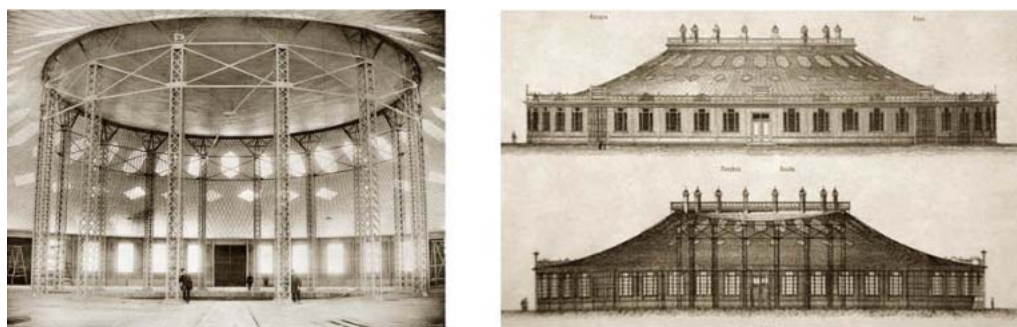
Shukhov Rotunda, 1896. Átrio Central, Elevação e Corte.
